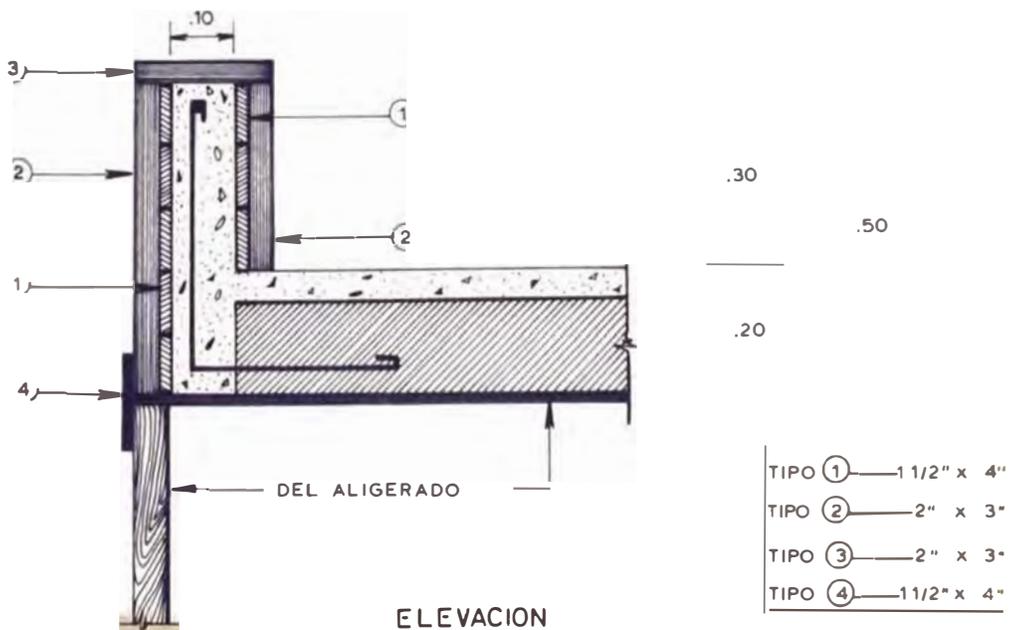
a ENCOFRADO BARANDA HALL ESCALERA. CORTE T-T
